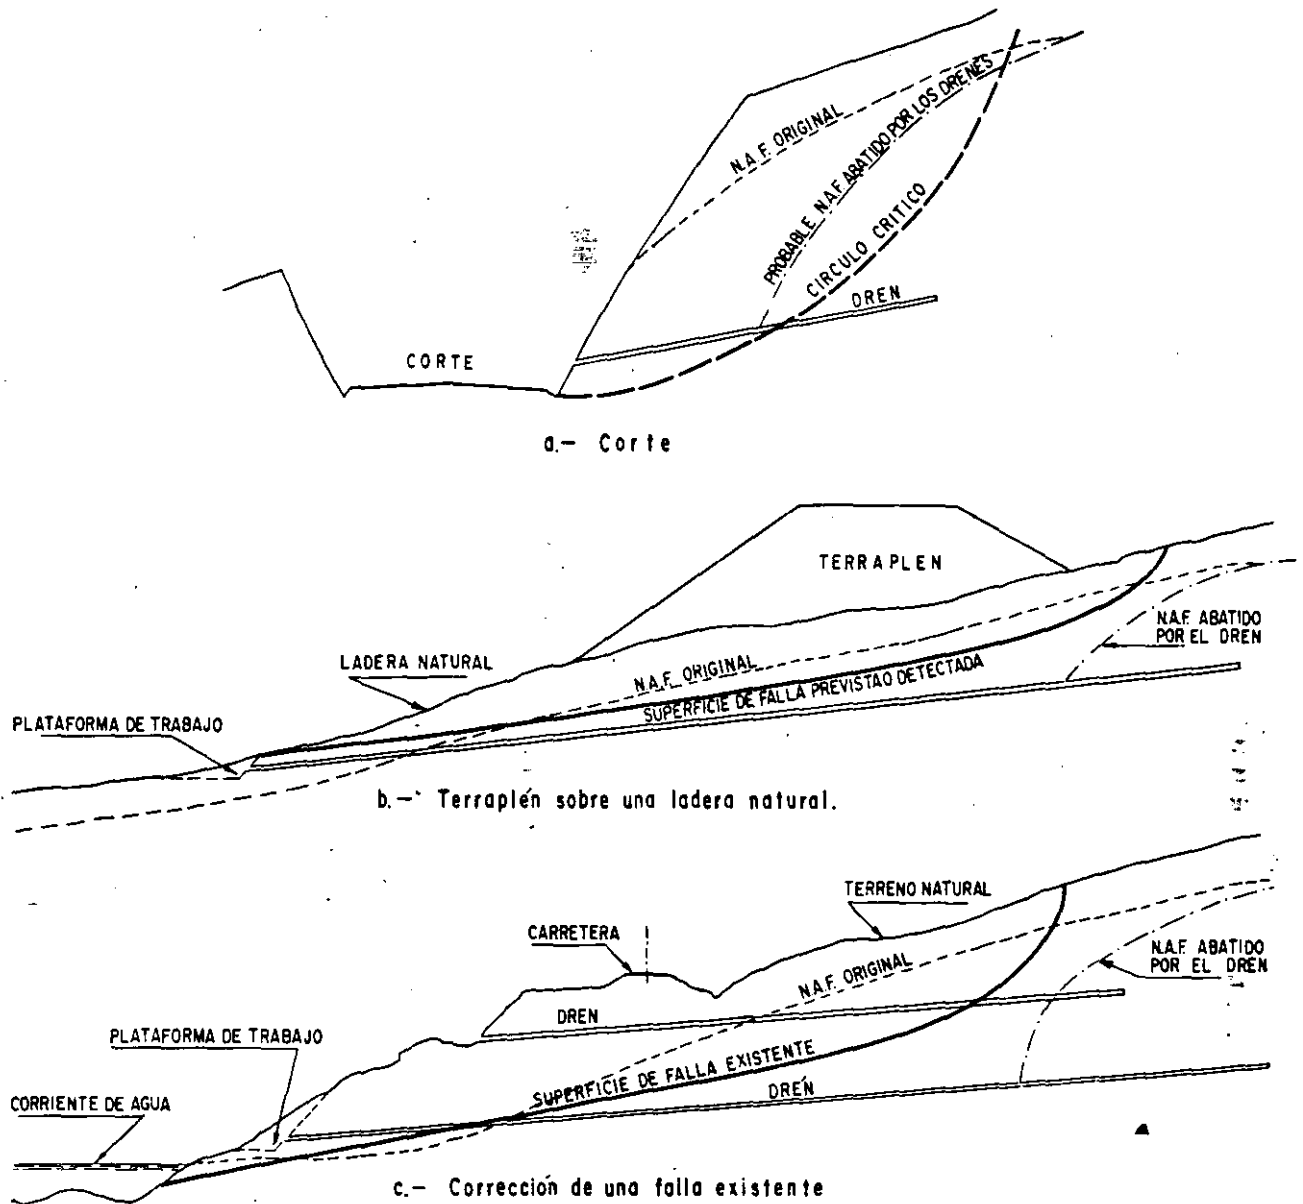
Croquis de la disposición de drenes transversales de penetración.
